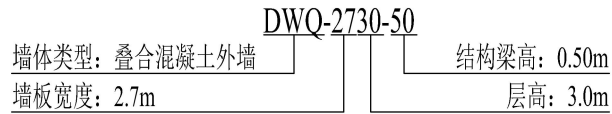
无洞口叠合混凝土外墙编号规则示意图
